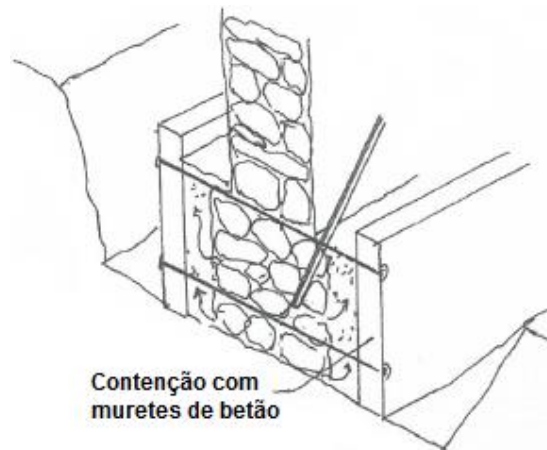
Esquema da consolidação com auxílio de muretes de betão [adaptado de 55]
